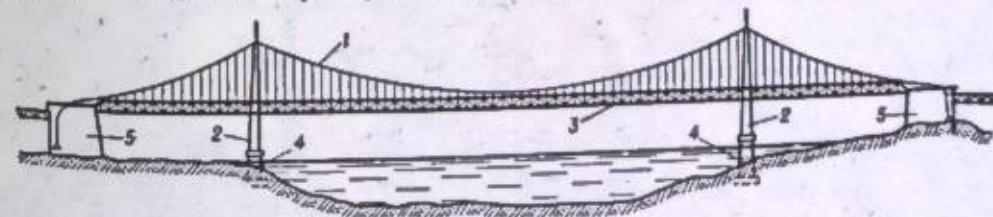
Схема висячего моста: 1 — кабель; 2 — пилон; 3 — балка (ферма) жесткости; 4 — промежуточная опора; 5 — анкерный устой.
